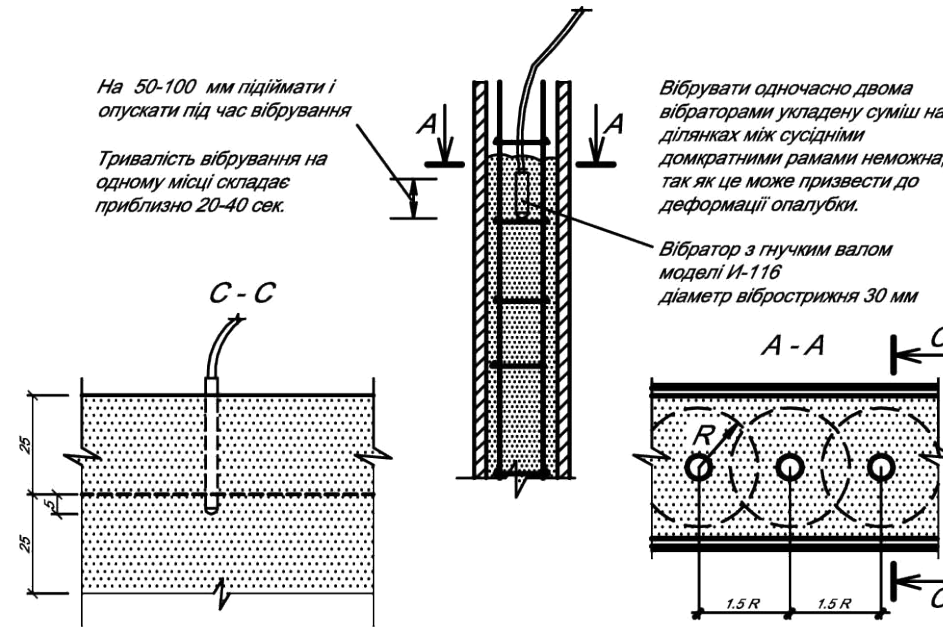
Віброуцільнення та укладка бетонної суміші стін силосу
